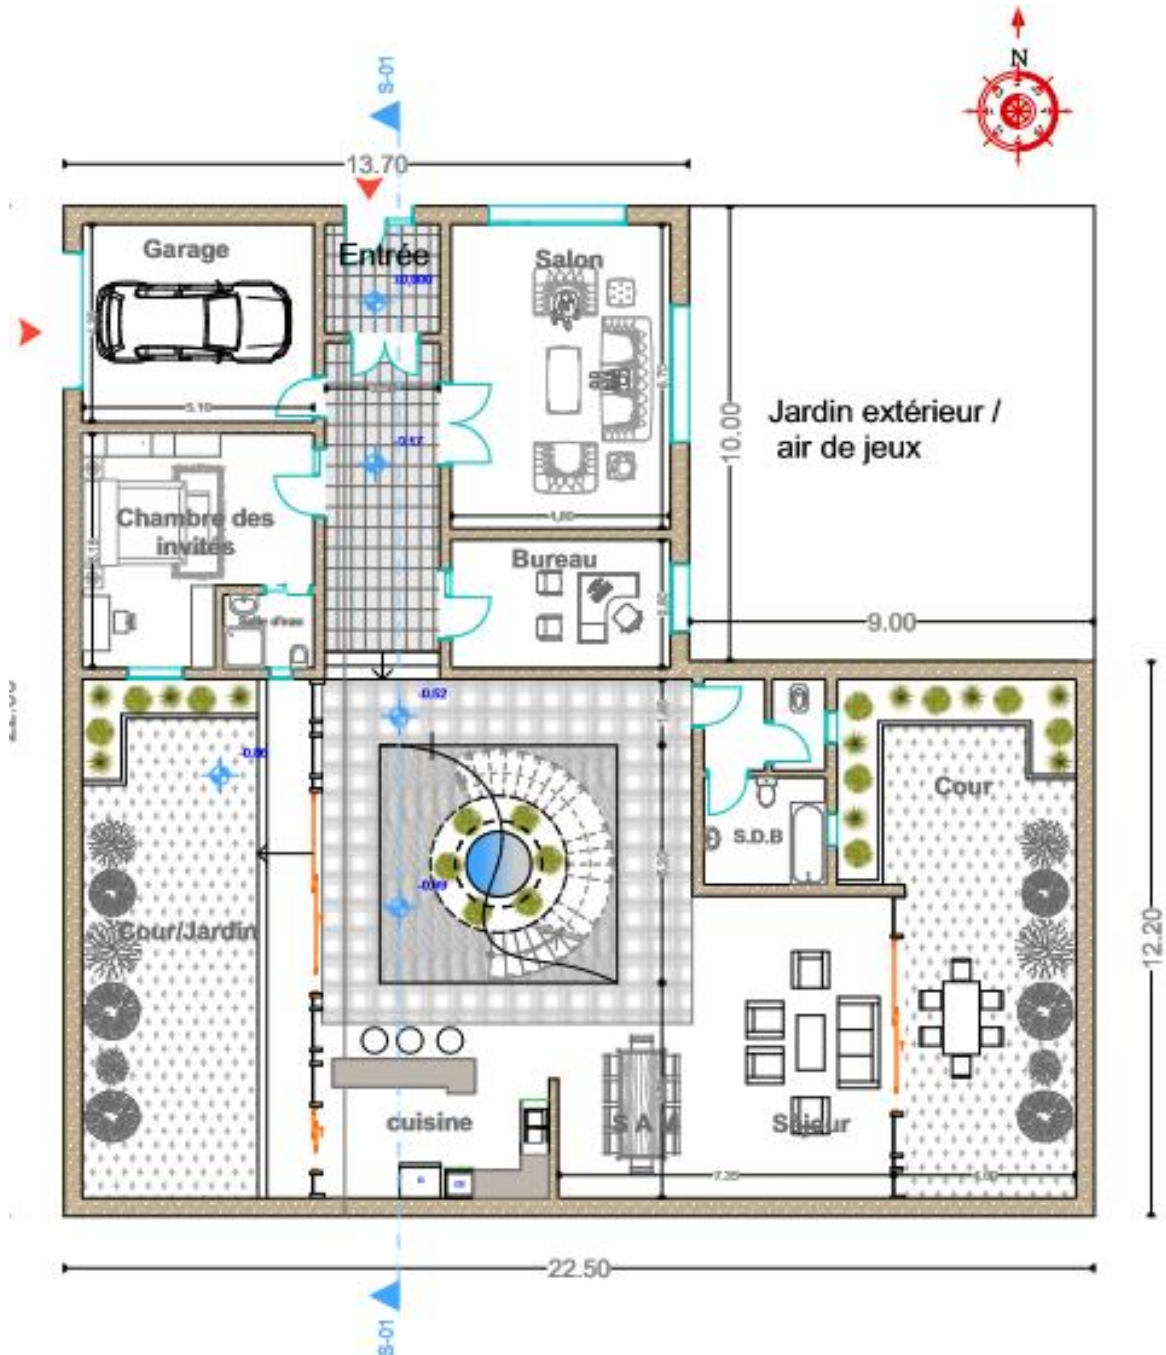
plan de Rez de Chaussée de cellule type I à l'échelle 1/100
